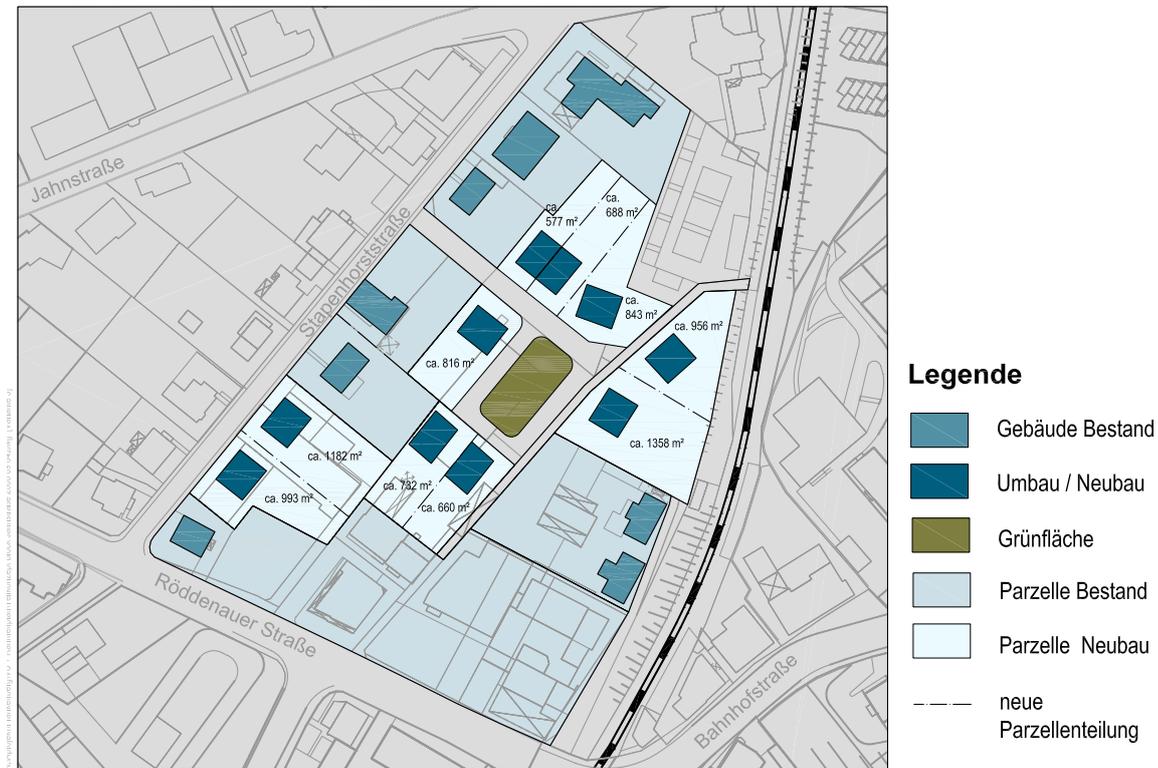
Bebauungsvariante der Grünfläche südöstlich der Stapenhorststraße (eigene Darstellung)
